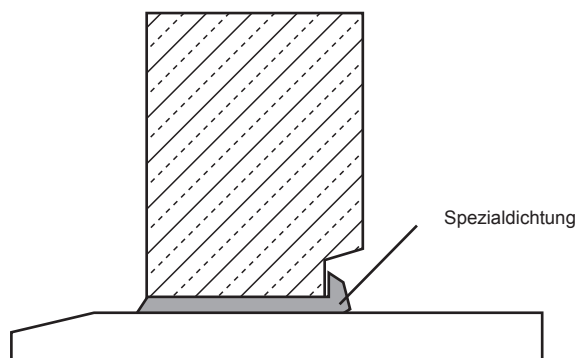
Spezialdichtung in Betonmauer
